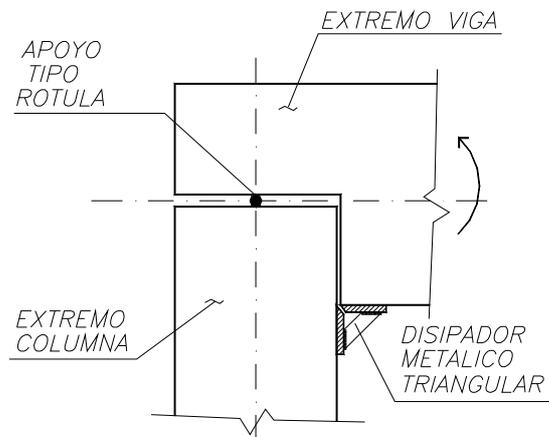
Planteo conceptual del disipador metálico de nudo
